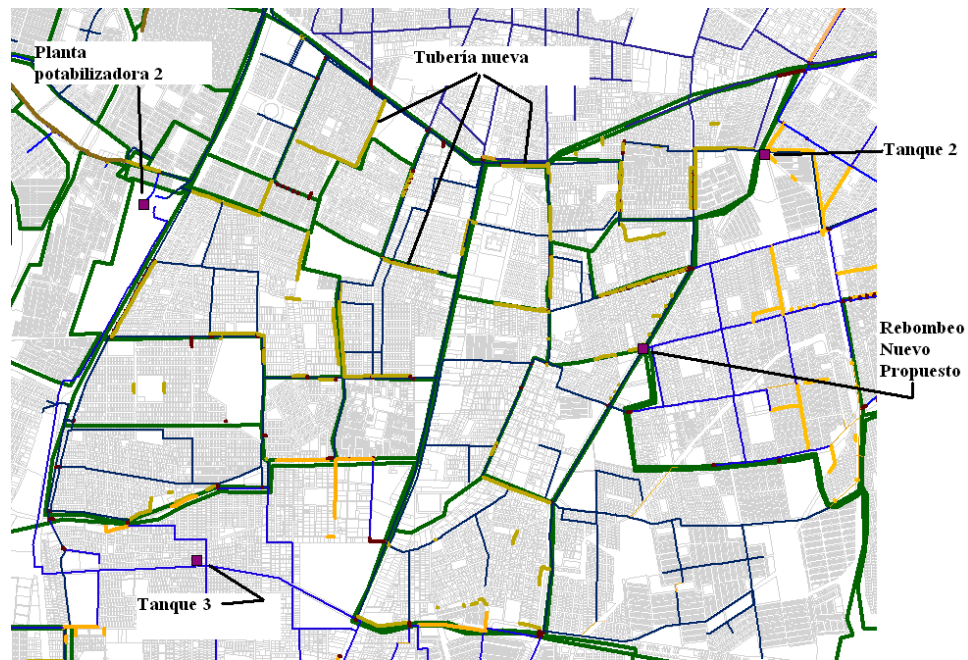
Tubería nueva en los sectores localizados al este de la Planta Potabilizadora 2
